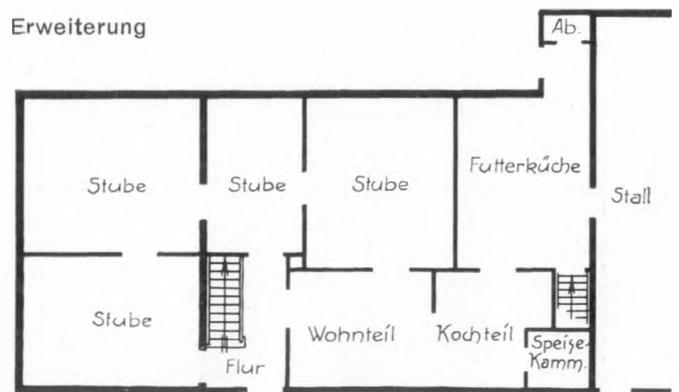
Dasselbe Wohnhaus nach erfolgtem Anbau von 2 Wohnräumen im Erdgeschoß. Zwei weitere Giebelzimmer können im Dachgeschoß ausgebaut werden.
